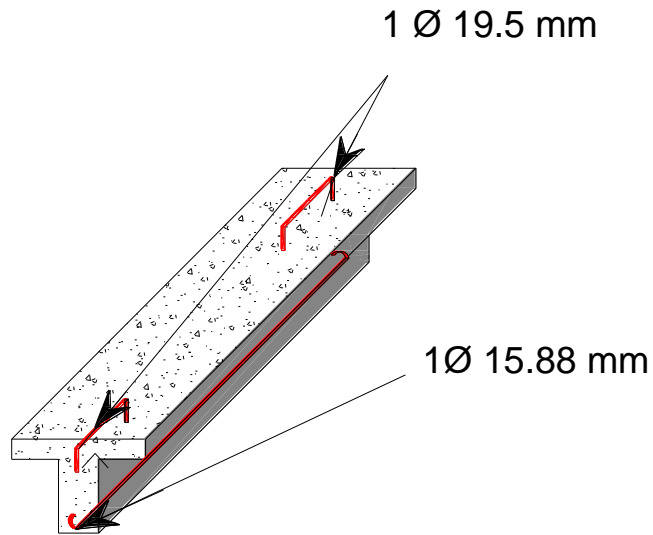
Armadura de acero de refuerzo del nervio longitudinal
